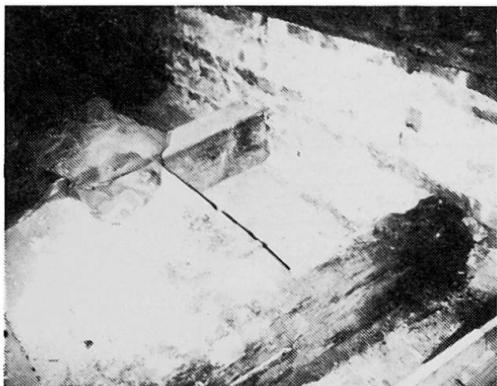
Deckenöffnung im Auflagerbereich einer Tramdecke (mit Fäulnisbefall)
